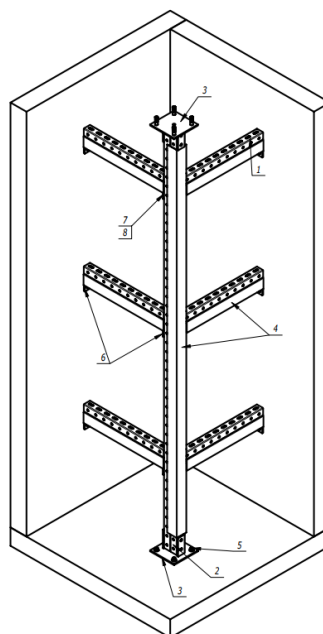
Крепление короба с одной стенкой к несущей поверхности вертикально
